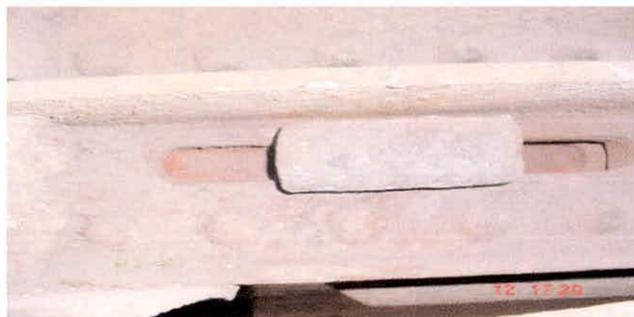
Lado opuesto de la cuña por el cual se debe halar una vez ha sido retirada la chaveta.
